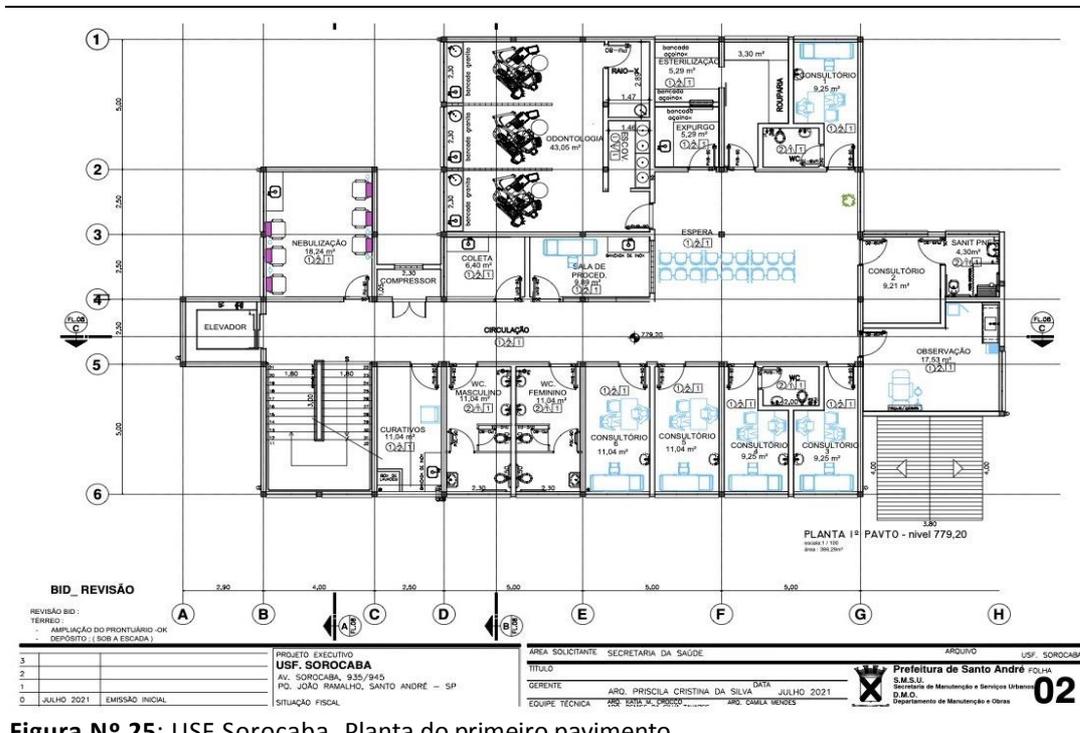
USF Sorocaba. Planta do primeiro pavimento
